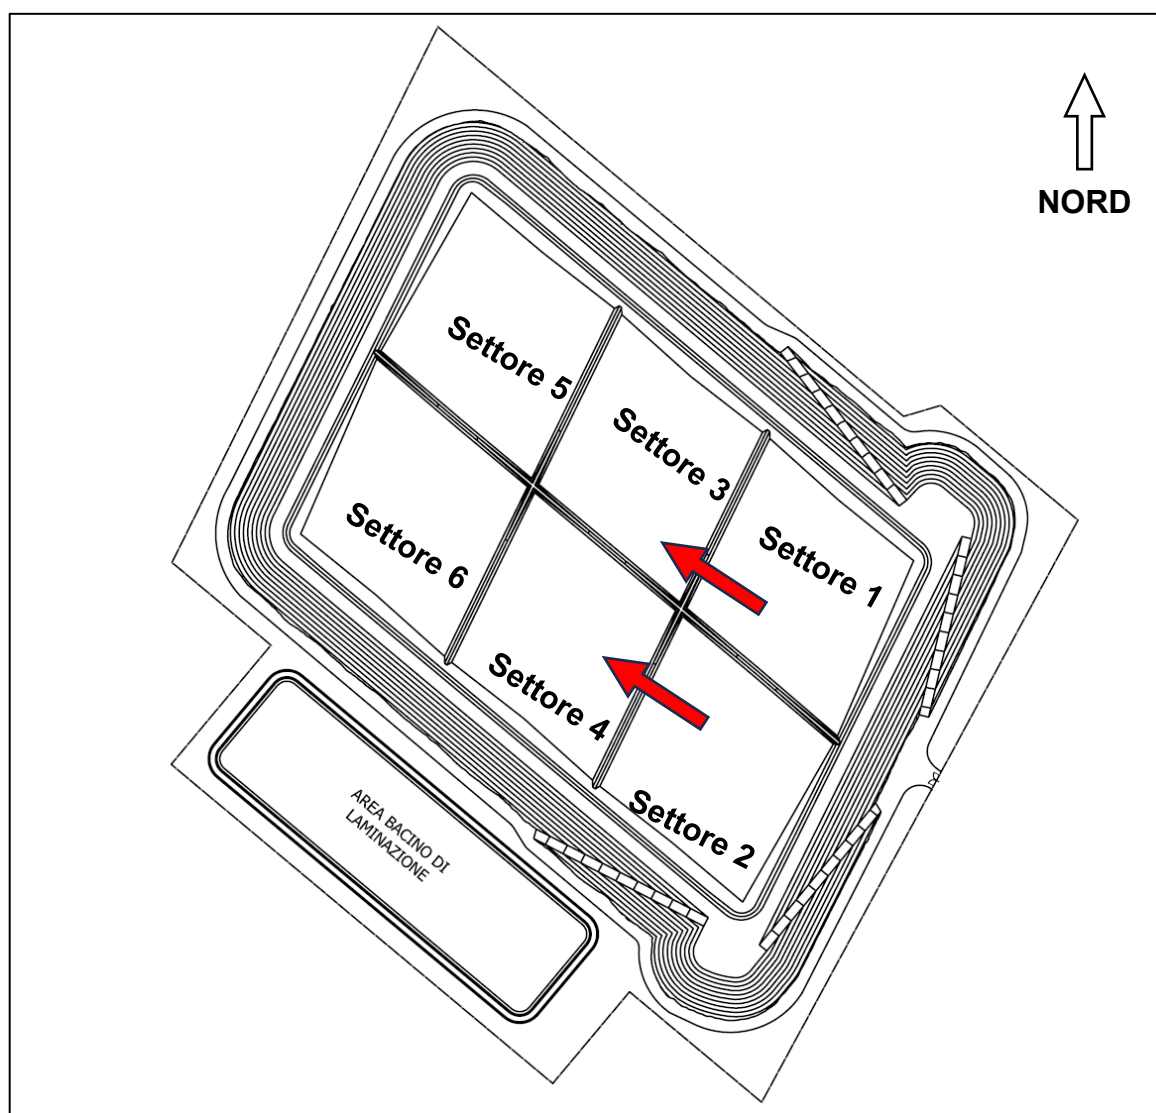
Planimetria dello stralcio di discarica di progetto con l'individuazione dei settori
